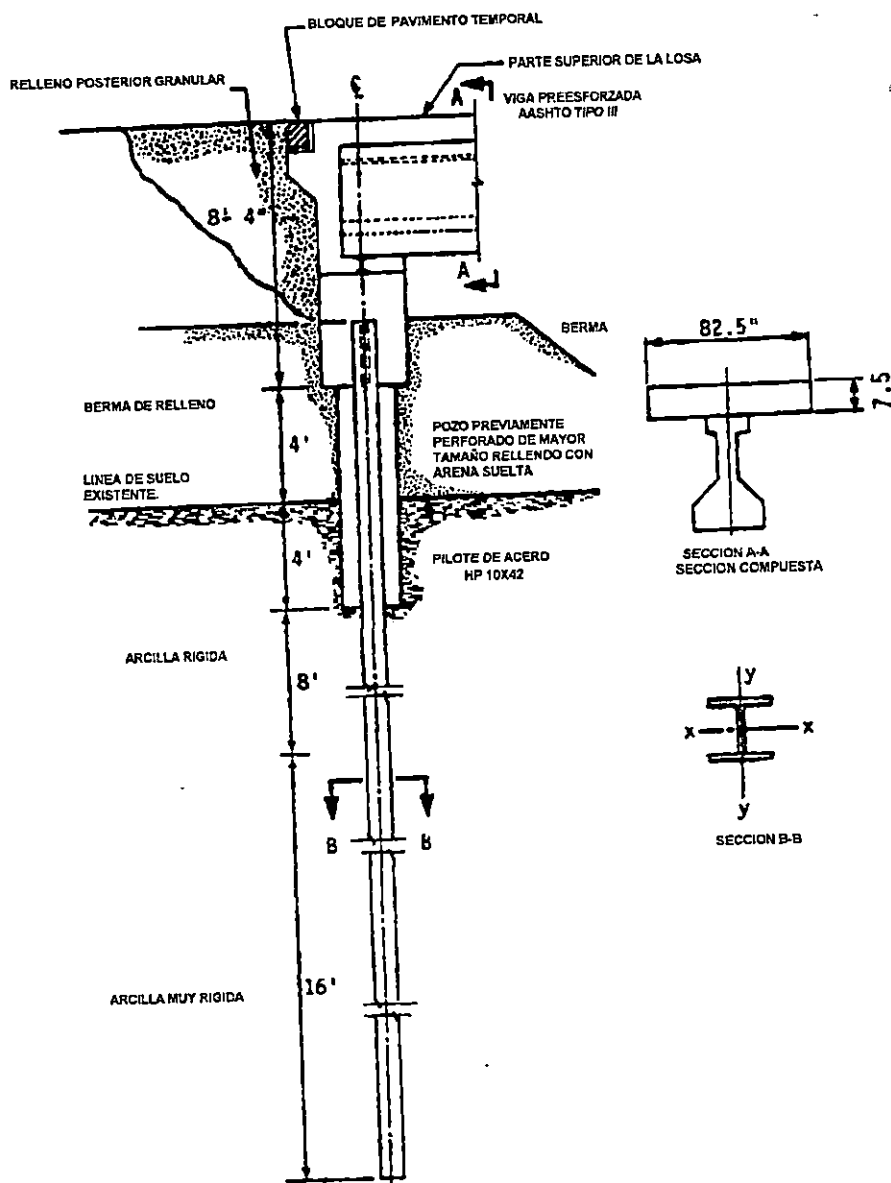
SECCION TIPICA A TRAVES DEL ESTRIBO Y EL PERFIL DE SUELO.
